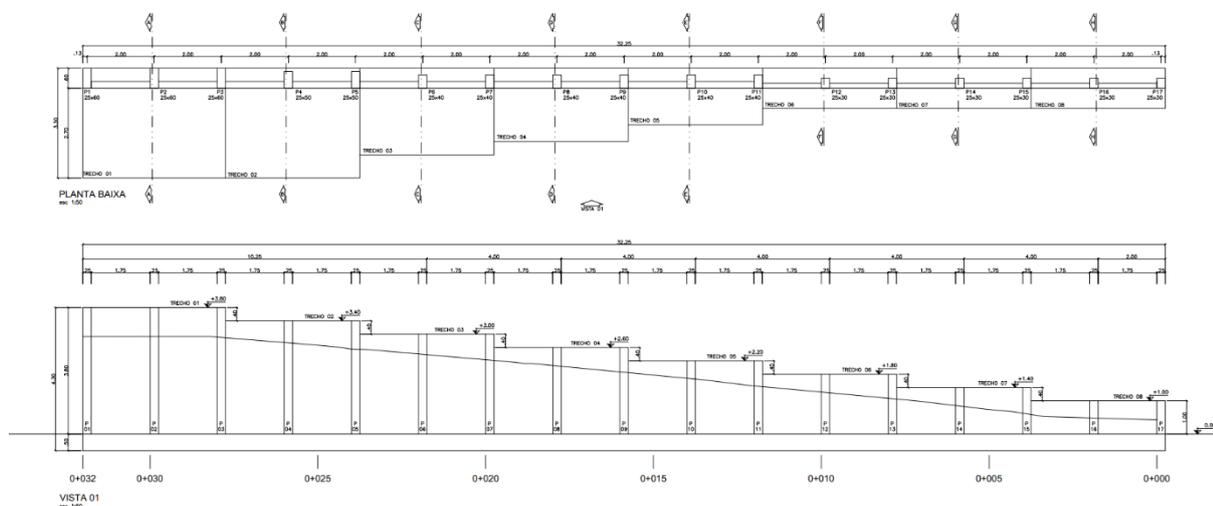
Planta baixa e vista frontal do muro de flexão a ser executado.
